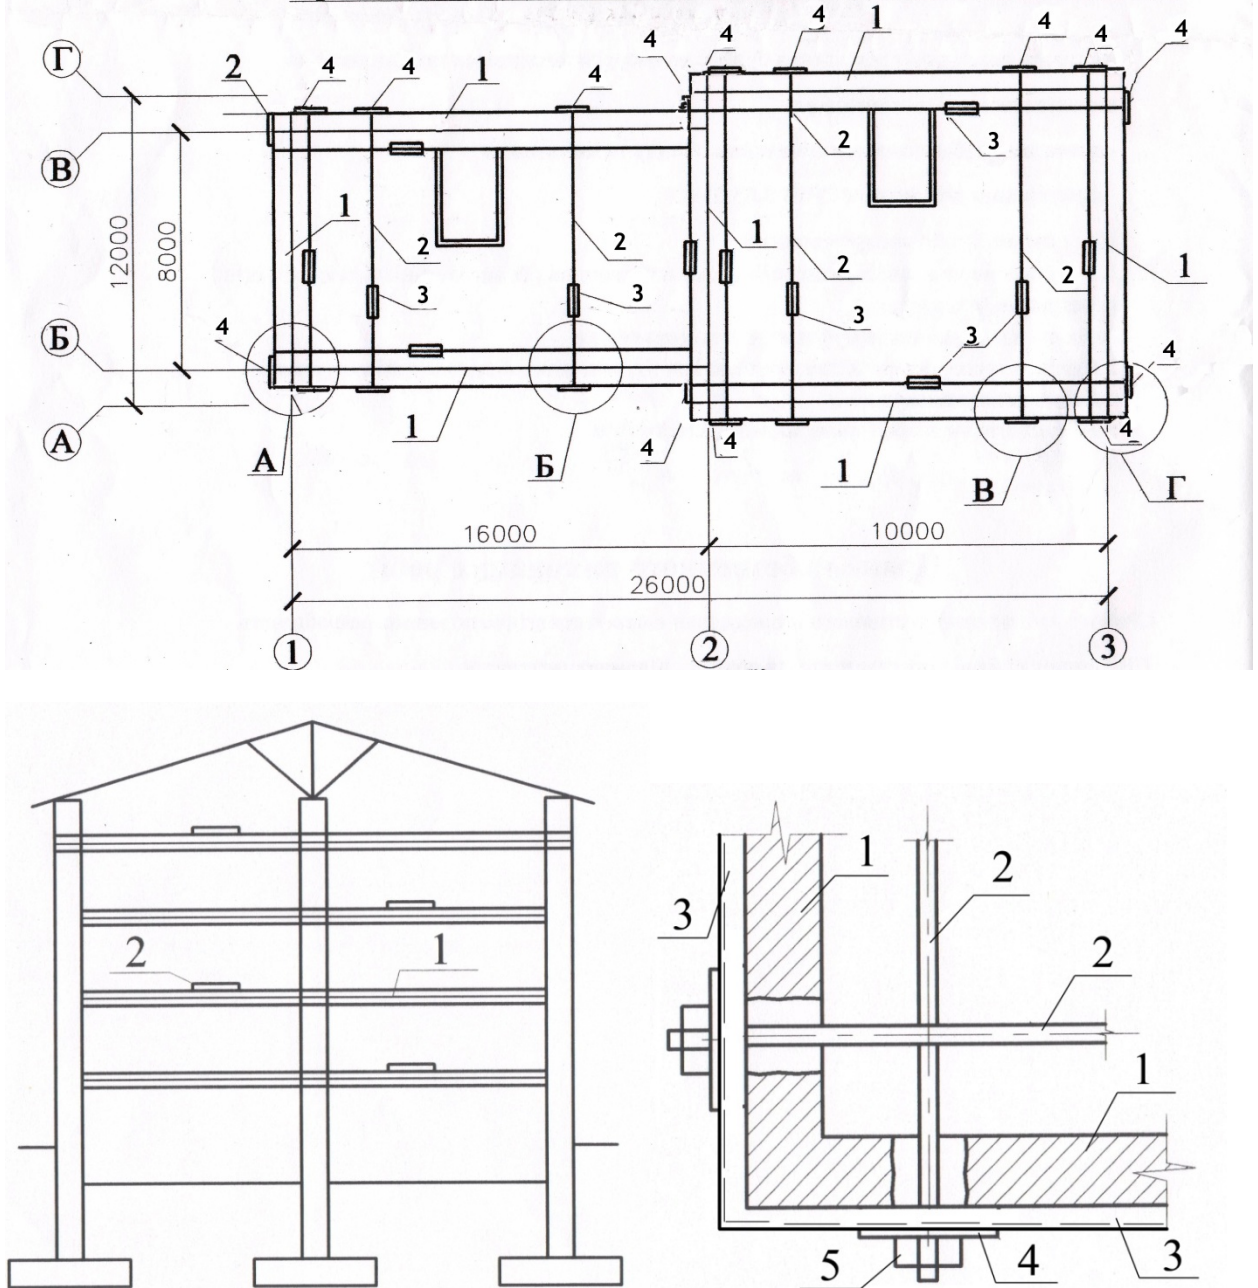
Схема реконструкції стін металевими тяжками в рівні перекриттів
